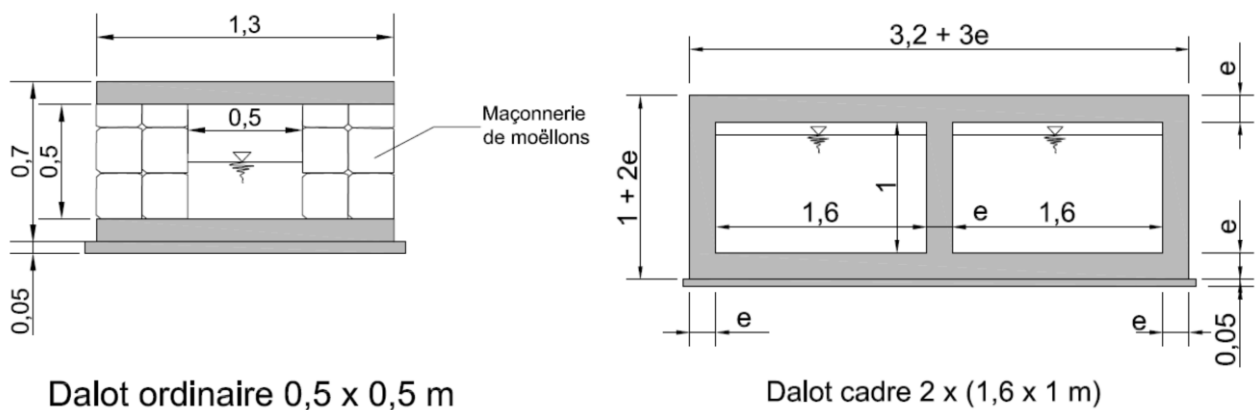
Sections transversales des dalots étudiés, dimensions en [m]
